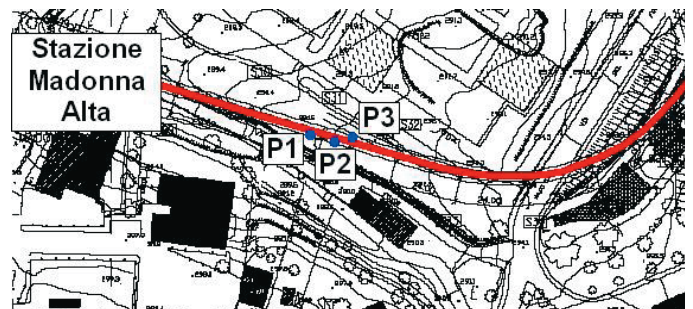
Particolare della planimetria del tracciato e posizione dei punti di misura (P1, P2, P3)
